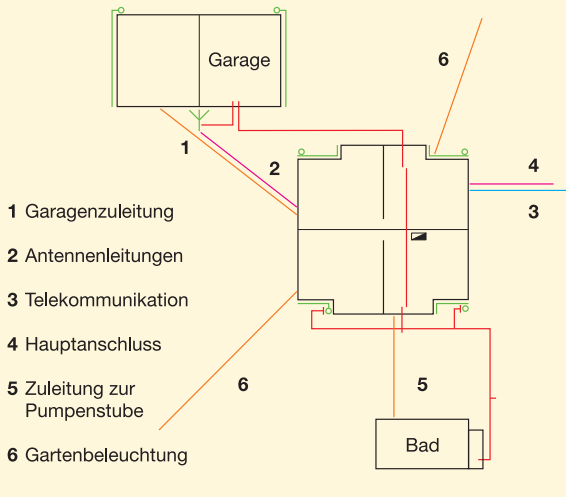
Grundrissdarstellung des Objekts mit seiner erdgebundenen E-Installation vor der Konzeptumsetzung.
